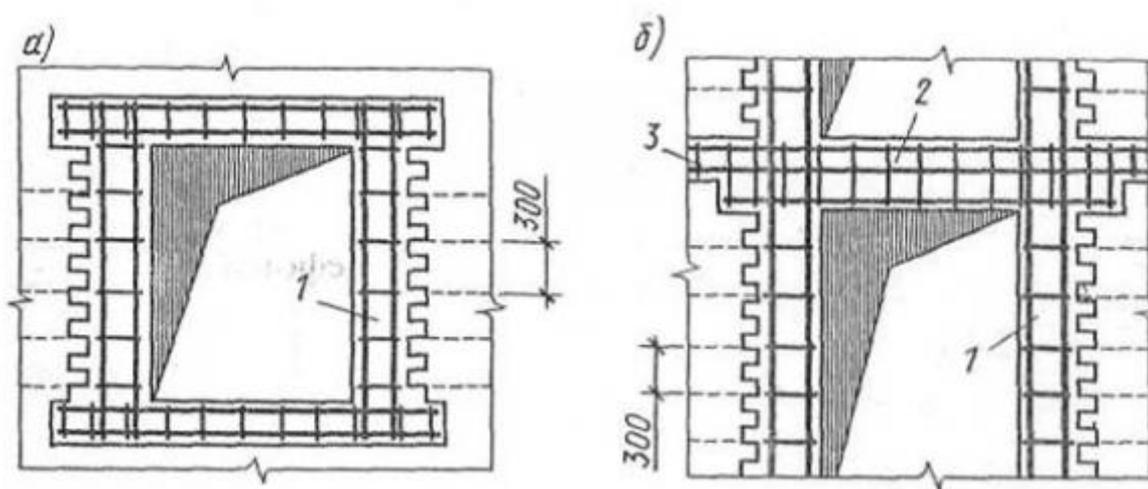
Усиление граней оконных (а) и дверных (б) проемов: 1 - железобетонный сердечник; 2 - железобетонная перемычка, объединенная с обвязкой; 3 - железобетонная обвязка
